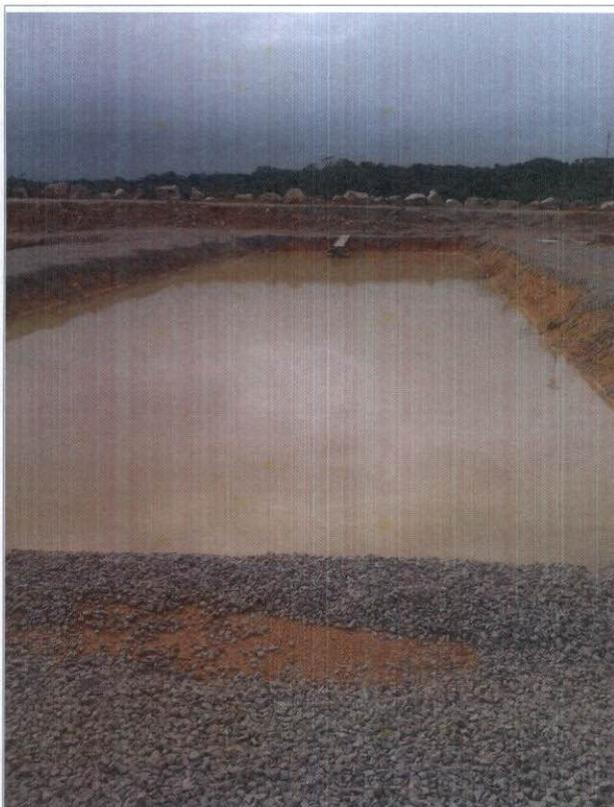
Tanque escavado onde se encontram as matrizes para reprodução
